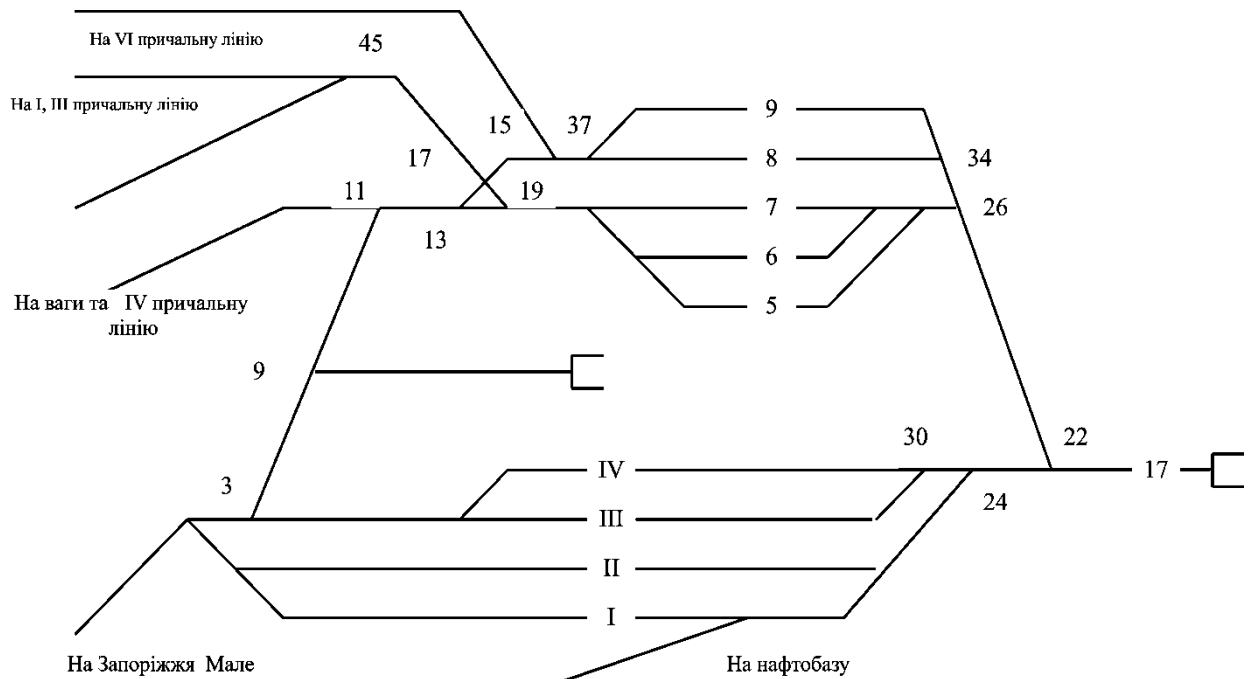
Схема колійного розвитку станції Порт Велике Запоріжжя
